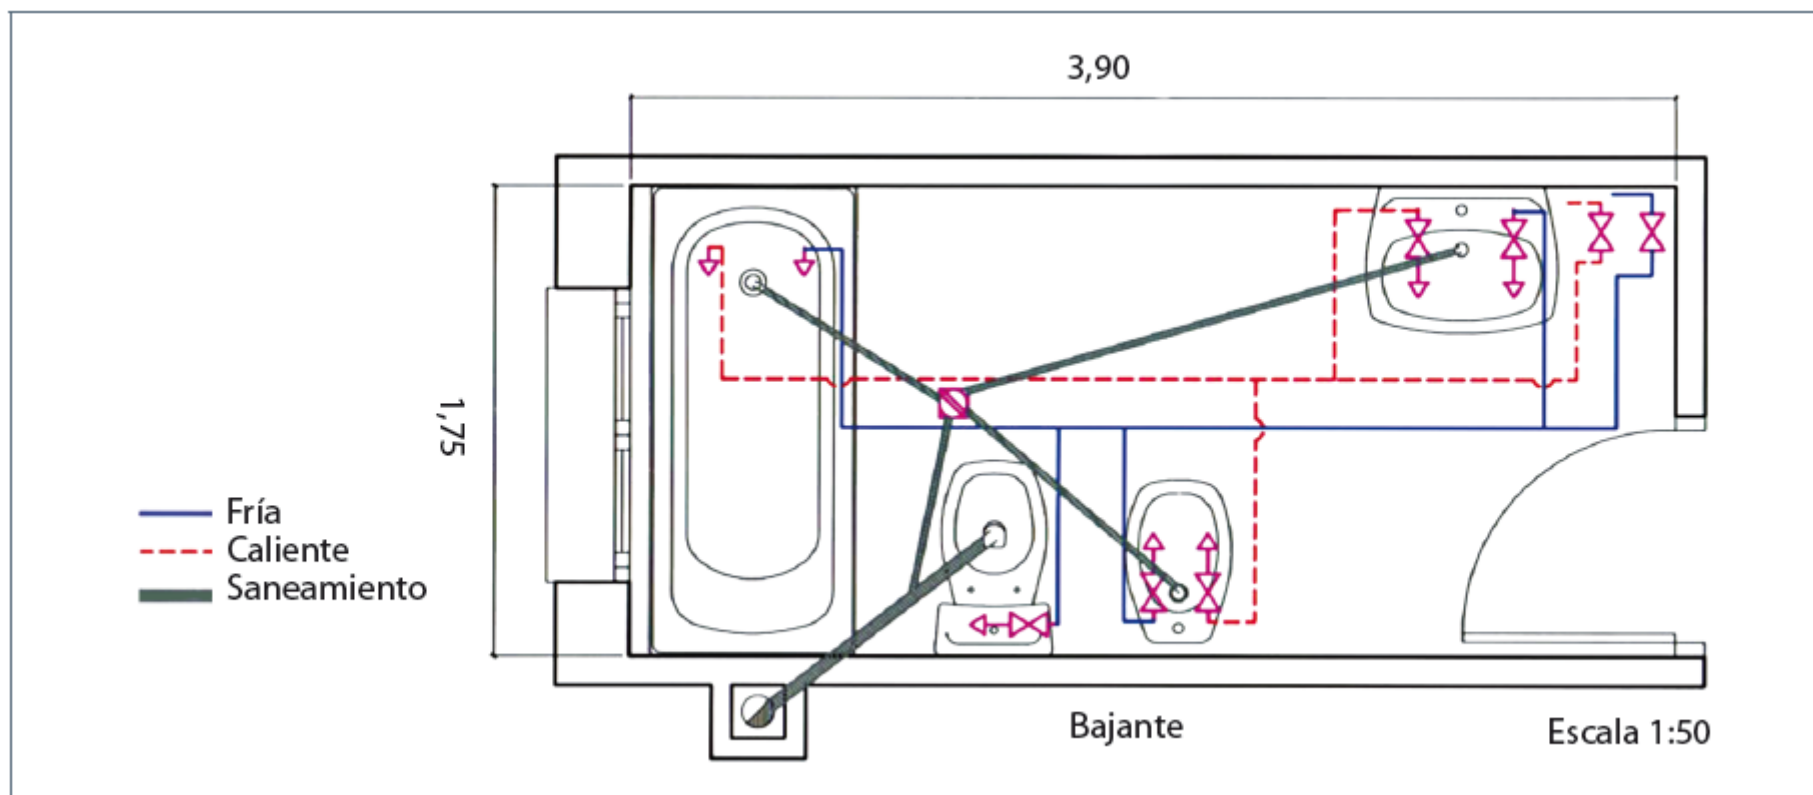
Plano de la instalación de fontanería de un cuarto de baño.
